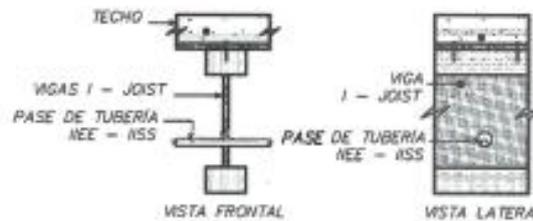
Detalle pase de IEE-ISS a través del techo
